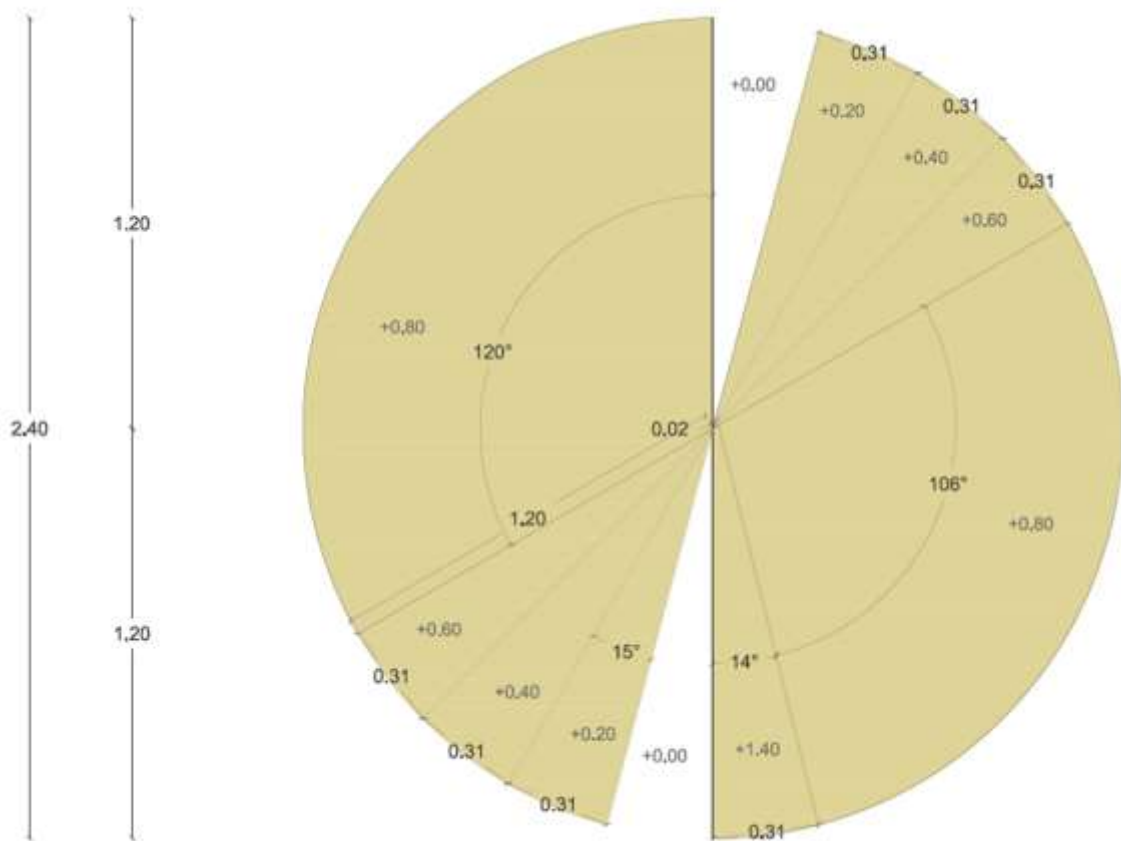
Dispositivo 3. Sumidero Sonar. Planta 4
